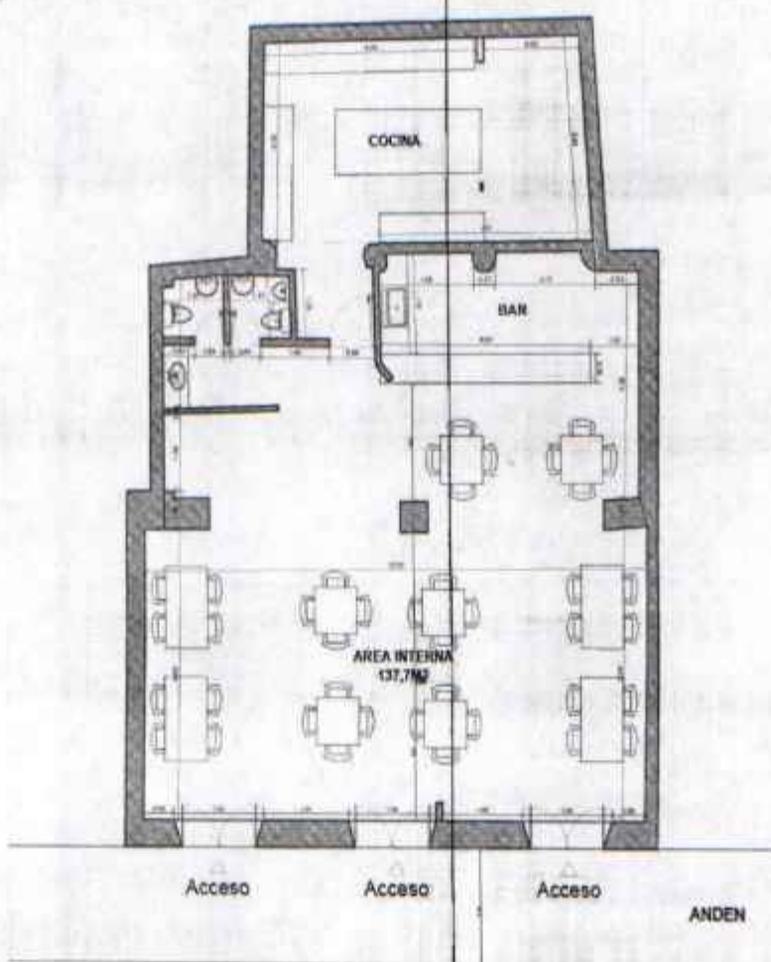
Plano RESTAURANTE ATAHUALPA -Área privada
